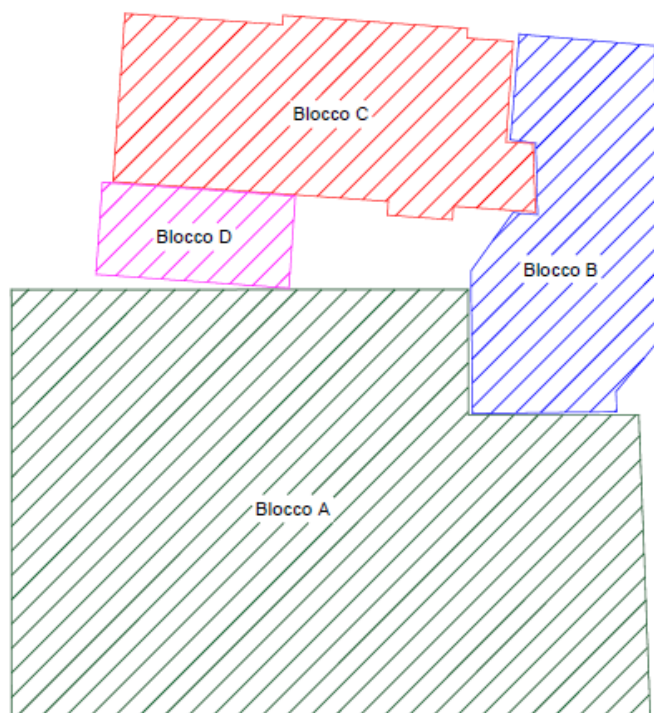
Planimetria con individuazione dei blocchi di fabbrica
